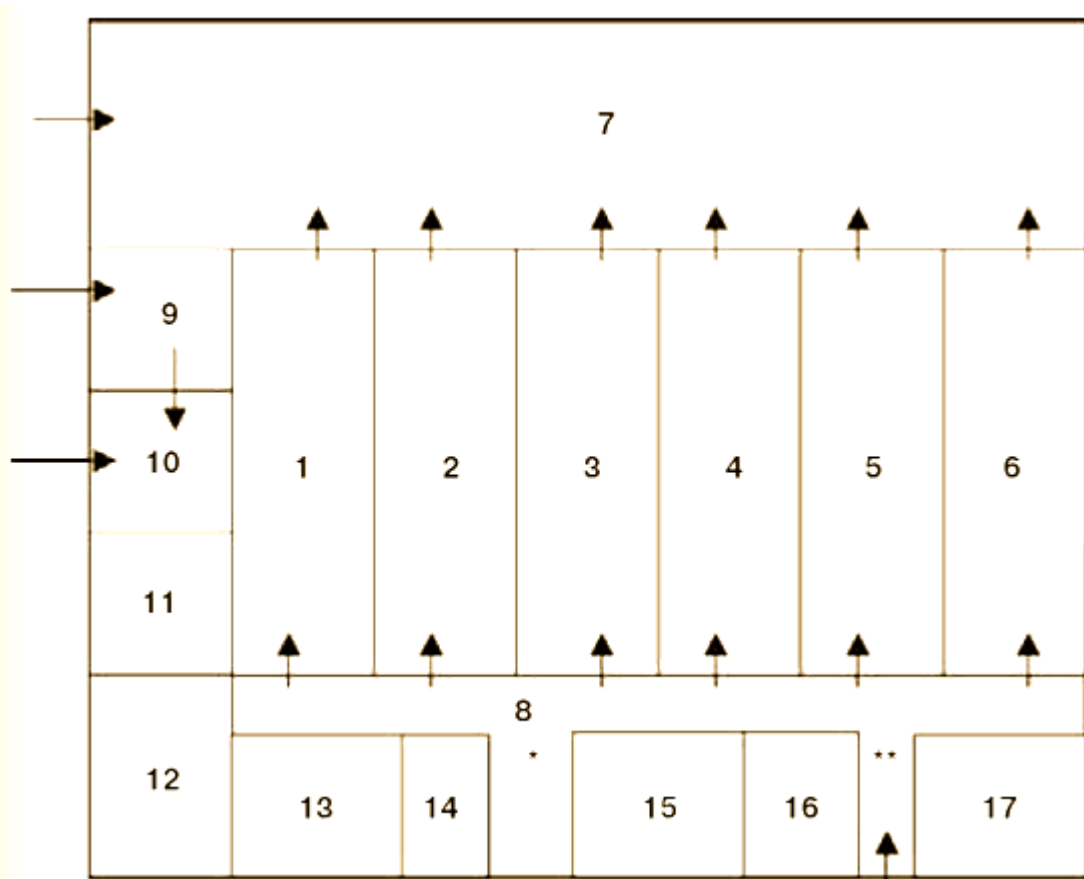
Схематичний план ферми на 6 камер для вирощування печериць
